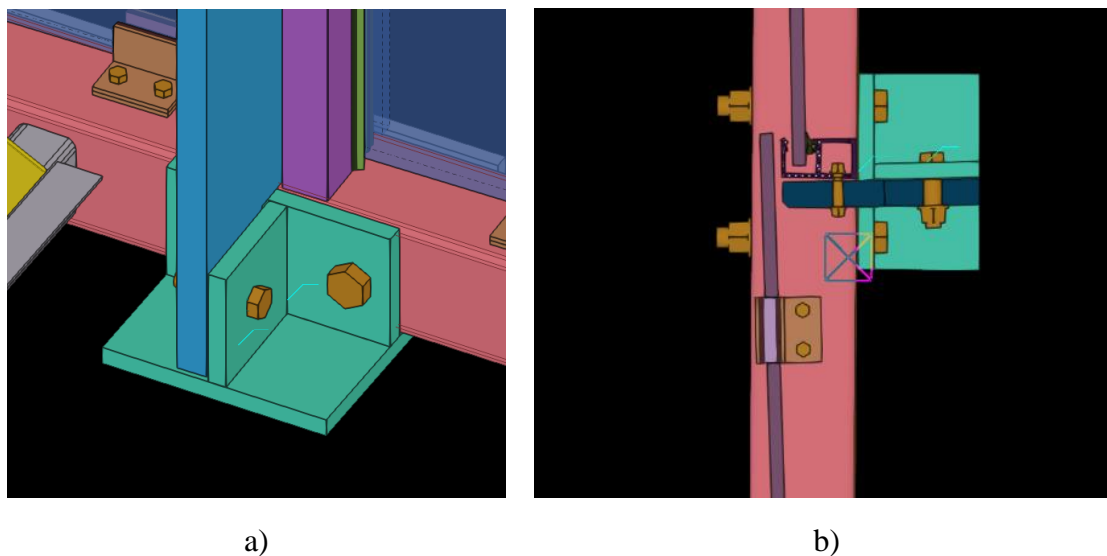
Pormenores construtivos: a) ligação da peça de amarração; b) detalhe em planta.
